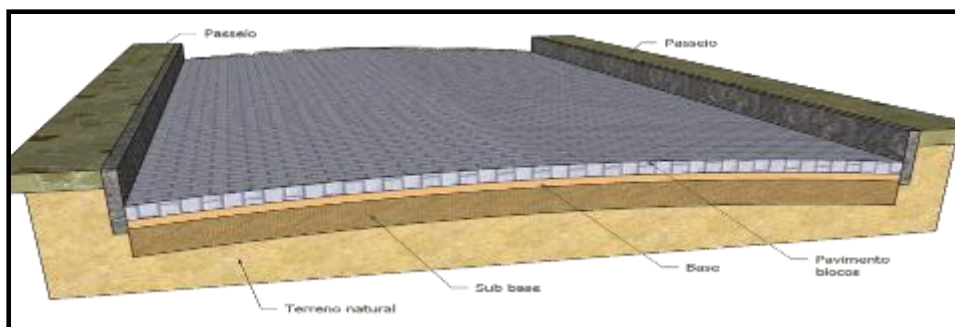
Desenho esquemático do perfil transversal da pavimentação com blocos
